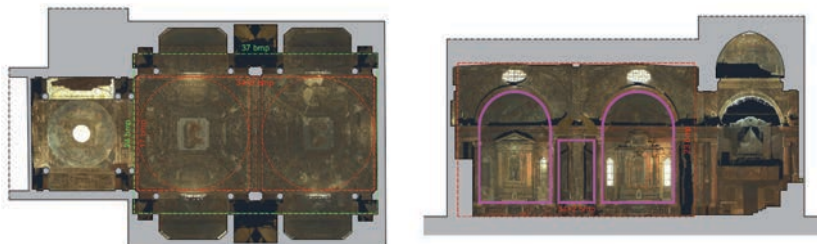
Chiesa di Sant' Alessandro: sezione orizzontale con immagine della volta vista dal basso e sezione verticale longitudinale.
